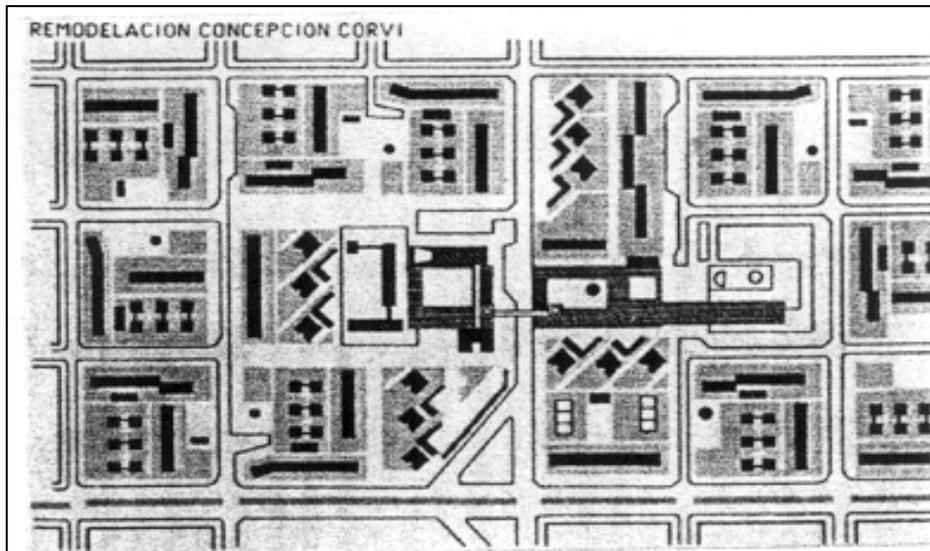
Remodelación Concepción. Planta de Conjunto. 1966 – '70.
